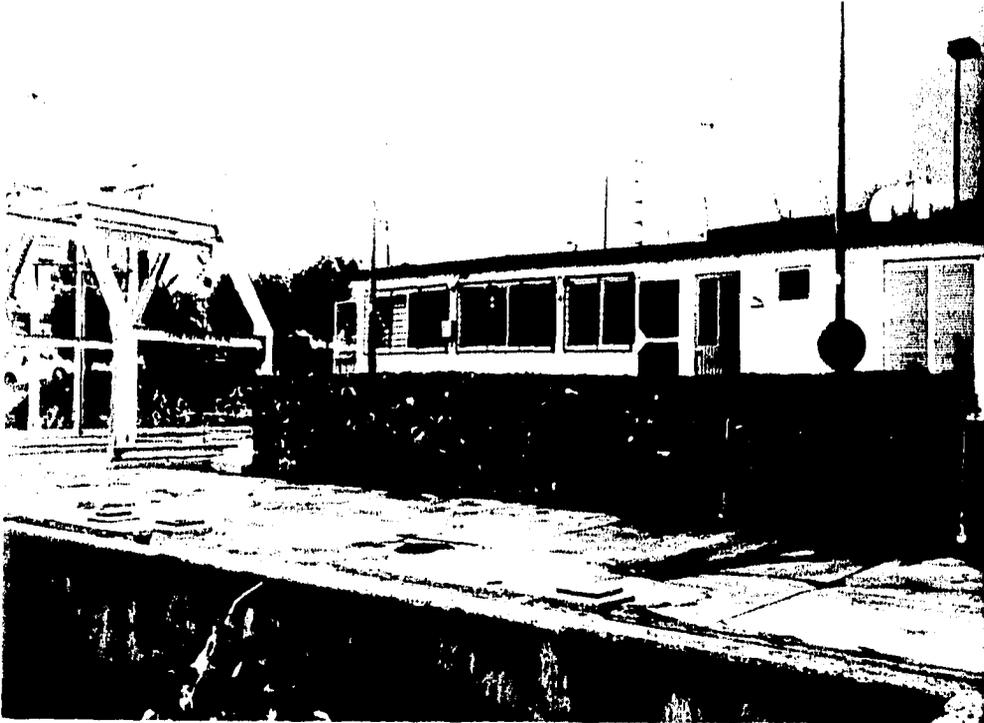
Caseta de control, central oleodinamica y grúa viajera en Atemajac
